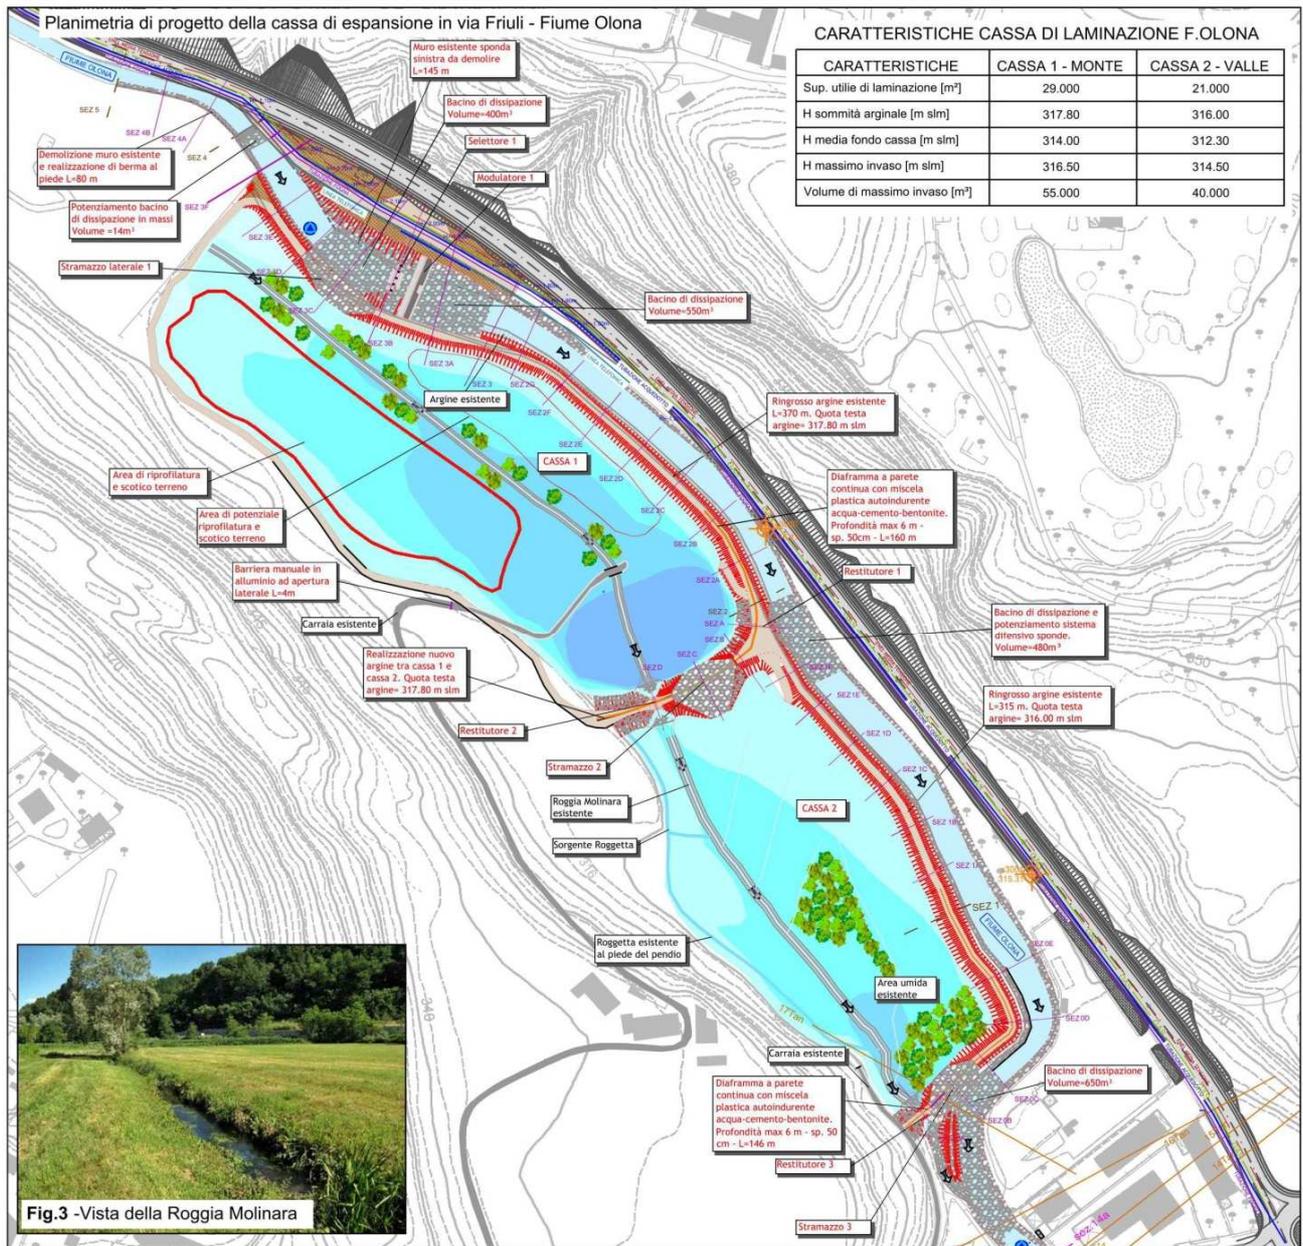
Planimetria di progetto vasche di laminazione Fiume Olona, via Friuli.
